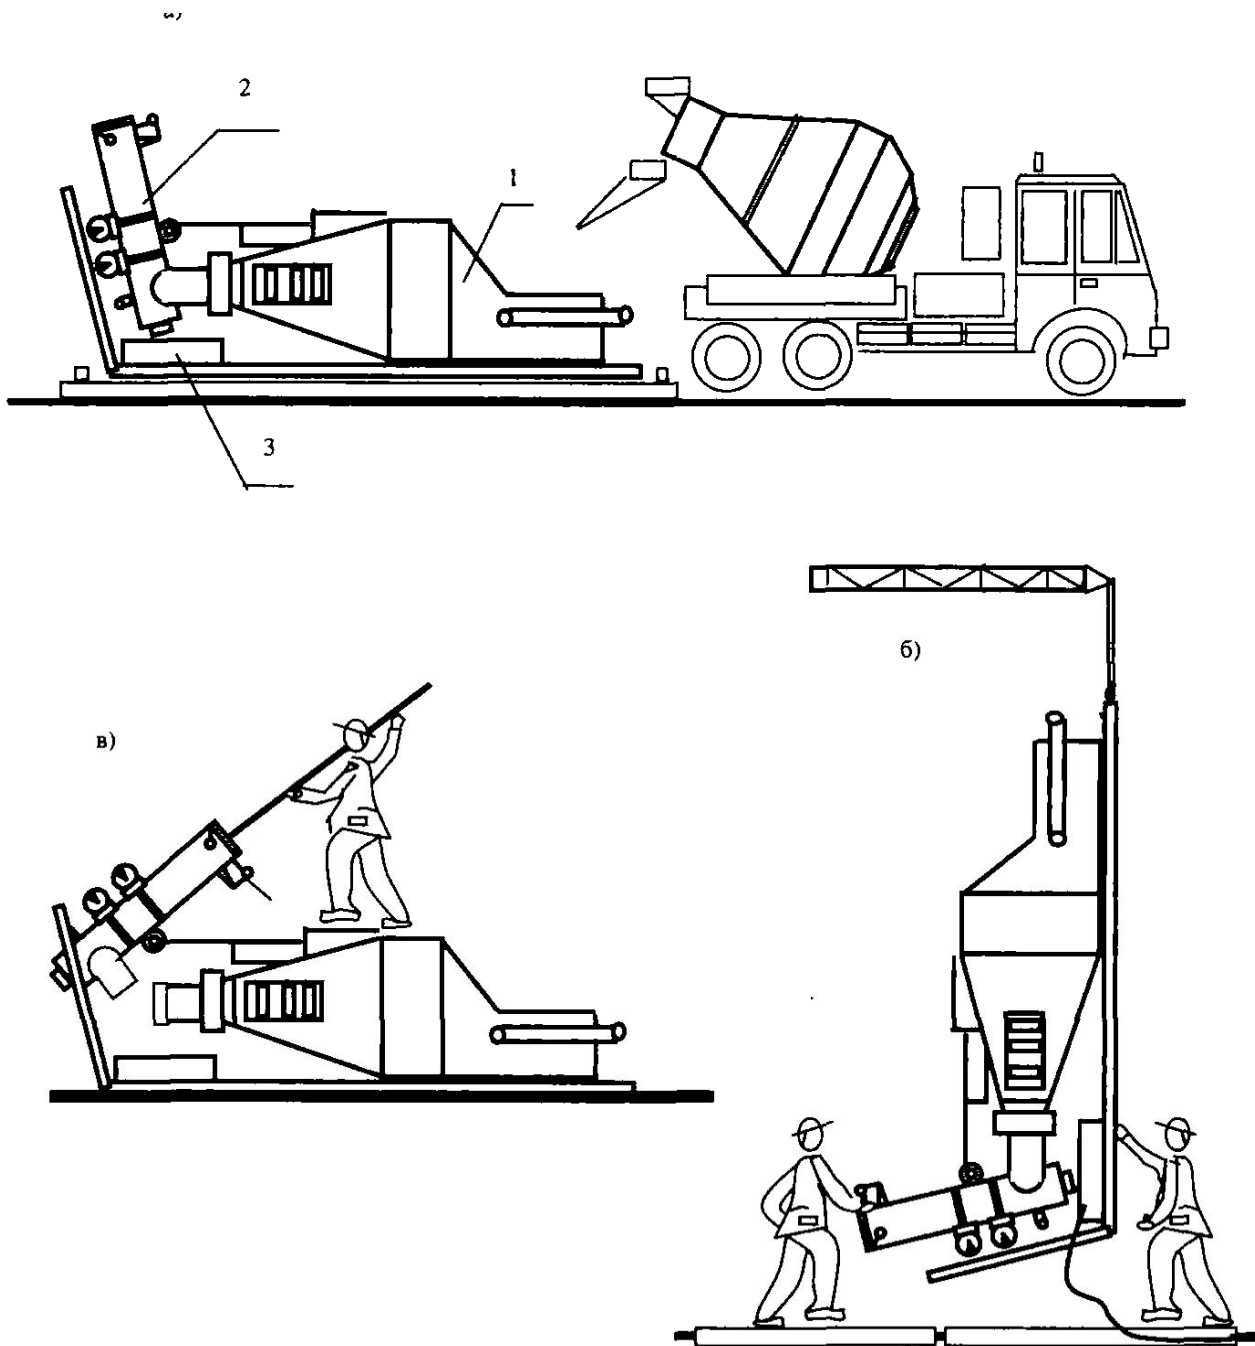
Поворотный бункер с приставкой для термовиброобработки бетонной смеси (БП-ТВОБС) в условиях строительной площадки.
